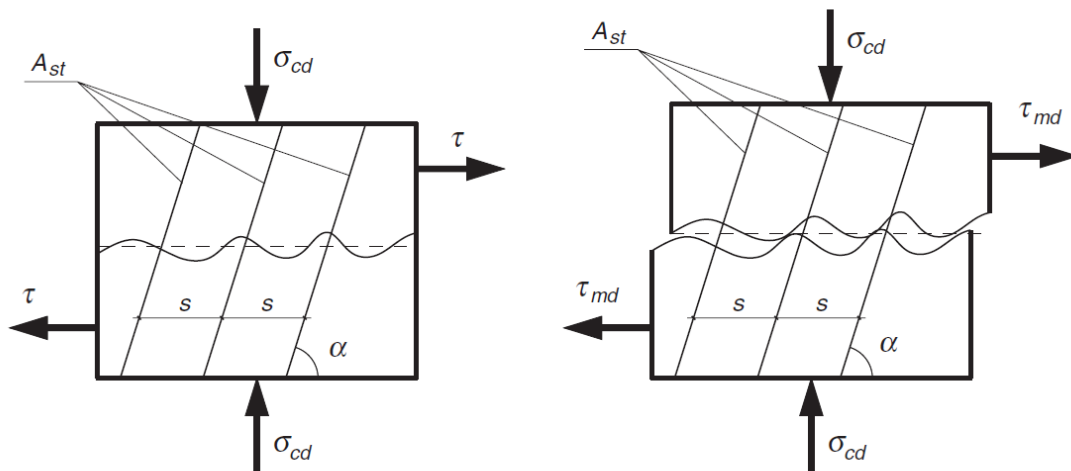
Cortante-fricción en una junta entre hormigones con armadura de cosido. [6]
